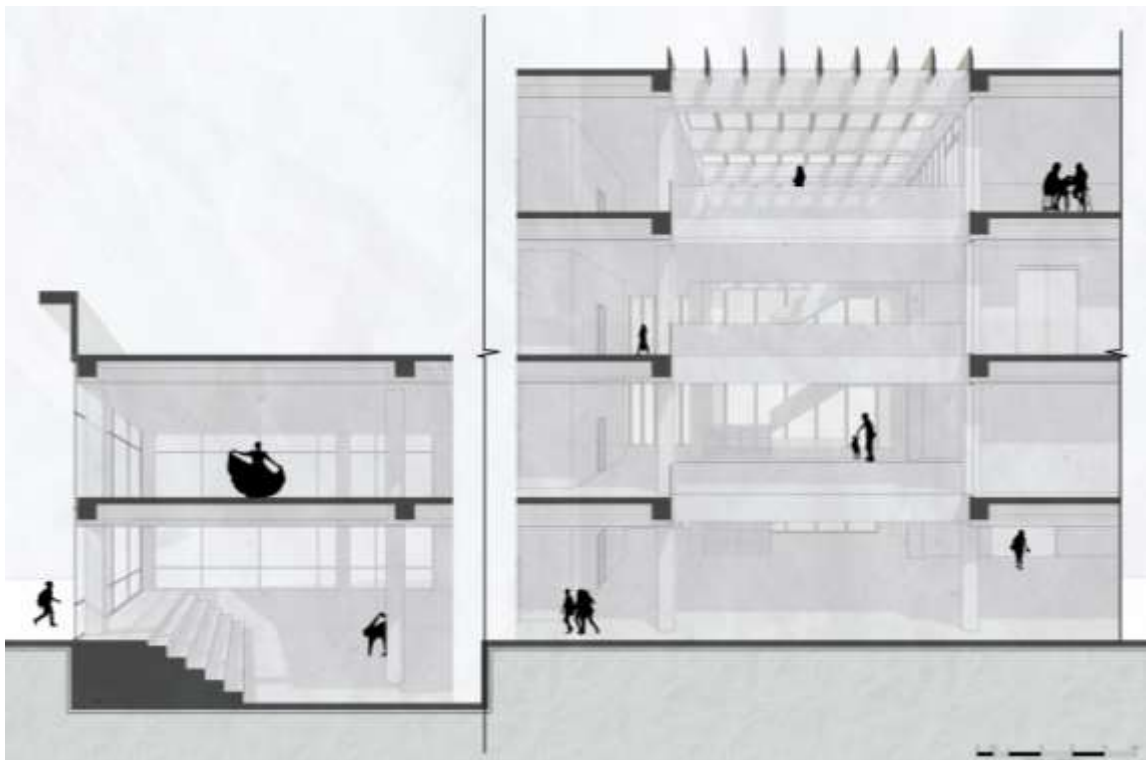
Fachada Este-Corte Fugado C. Elaboración propia
